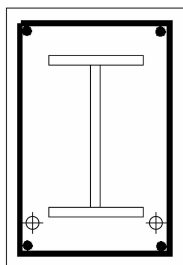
预应力型钢混凝土梁的型钢截面配筋形式
